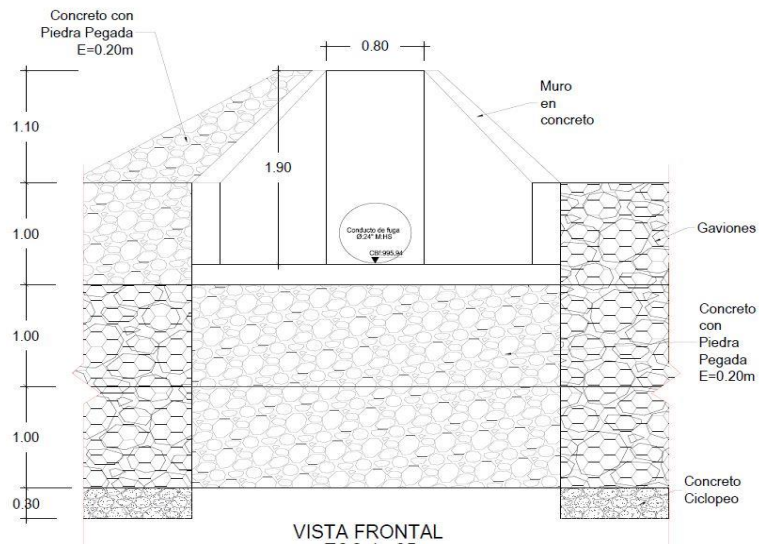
Detalle del cabezal y el muro en gavión de apoyo, vista frontal.
